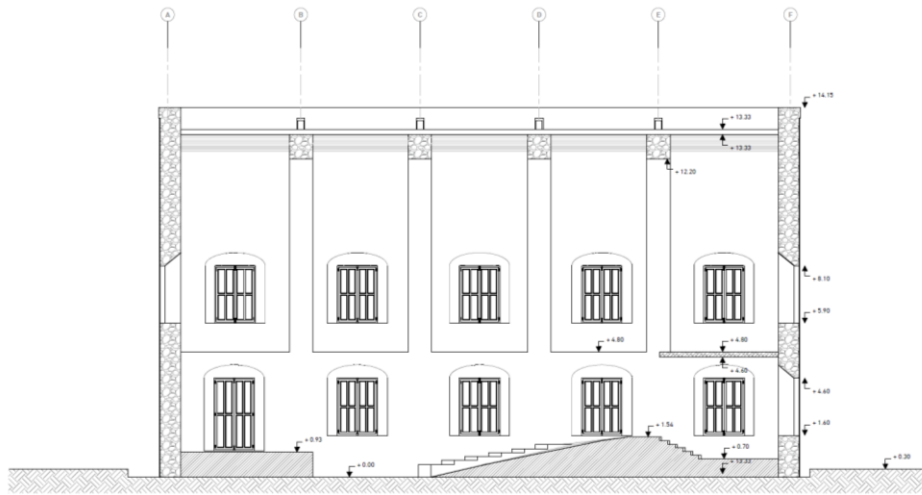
Sección 1.1 del Auditorio. Levantamiento realizado en el año 2019. Fuente: Autora. Ver Planos en los Anexos.
